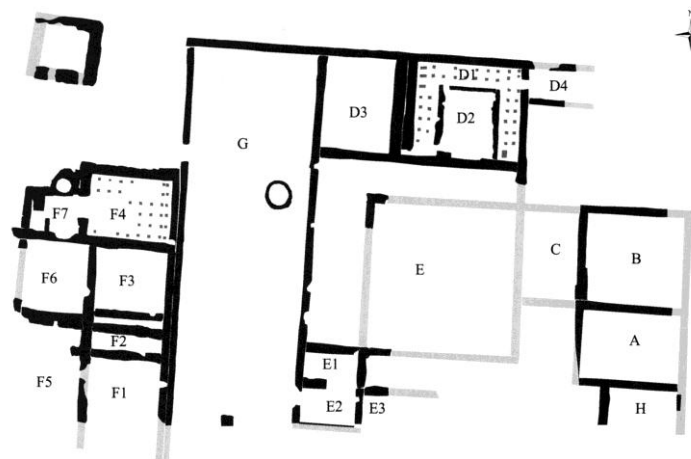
Grundriss ›ex Prepositura‹.
